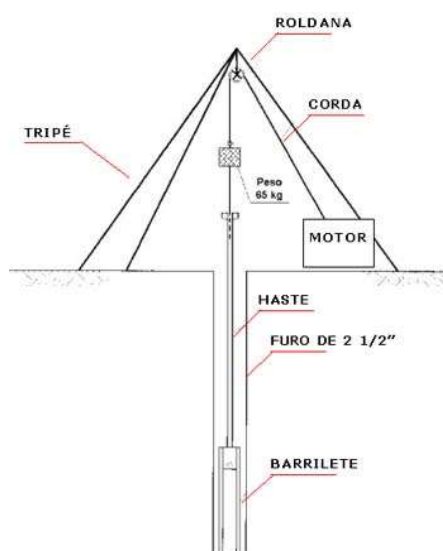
Ensaio SPT. Disponível em: [www.forumdaconstrução.com.br](http://www.forumdaconstrução.com.br). Acesso em 01/11/2018.
